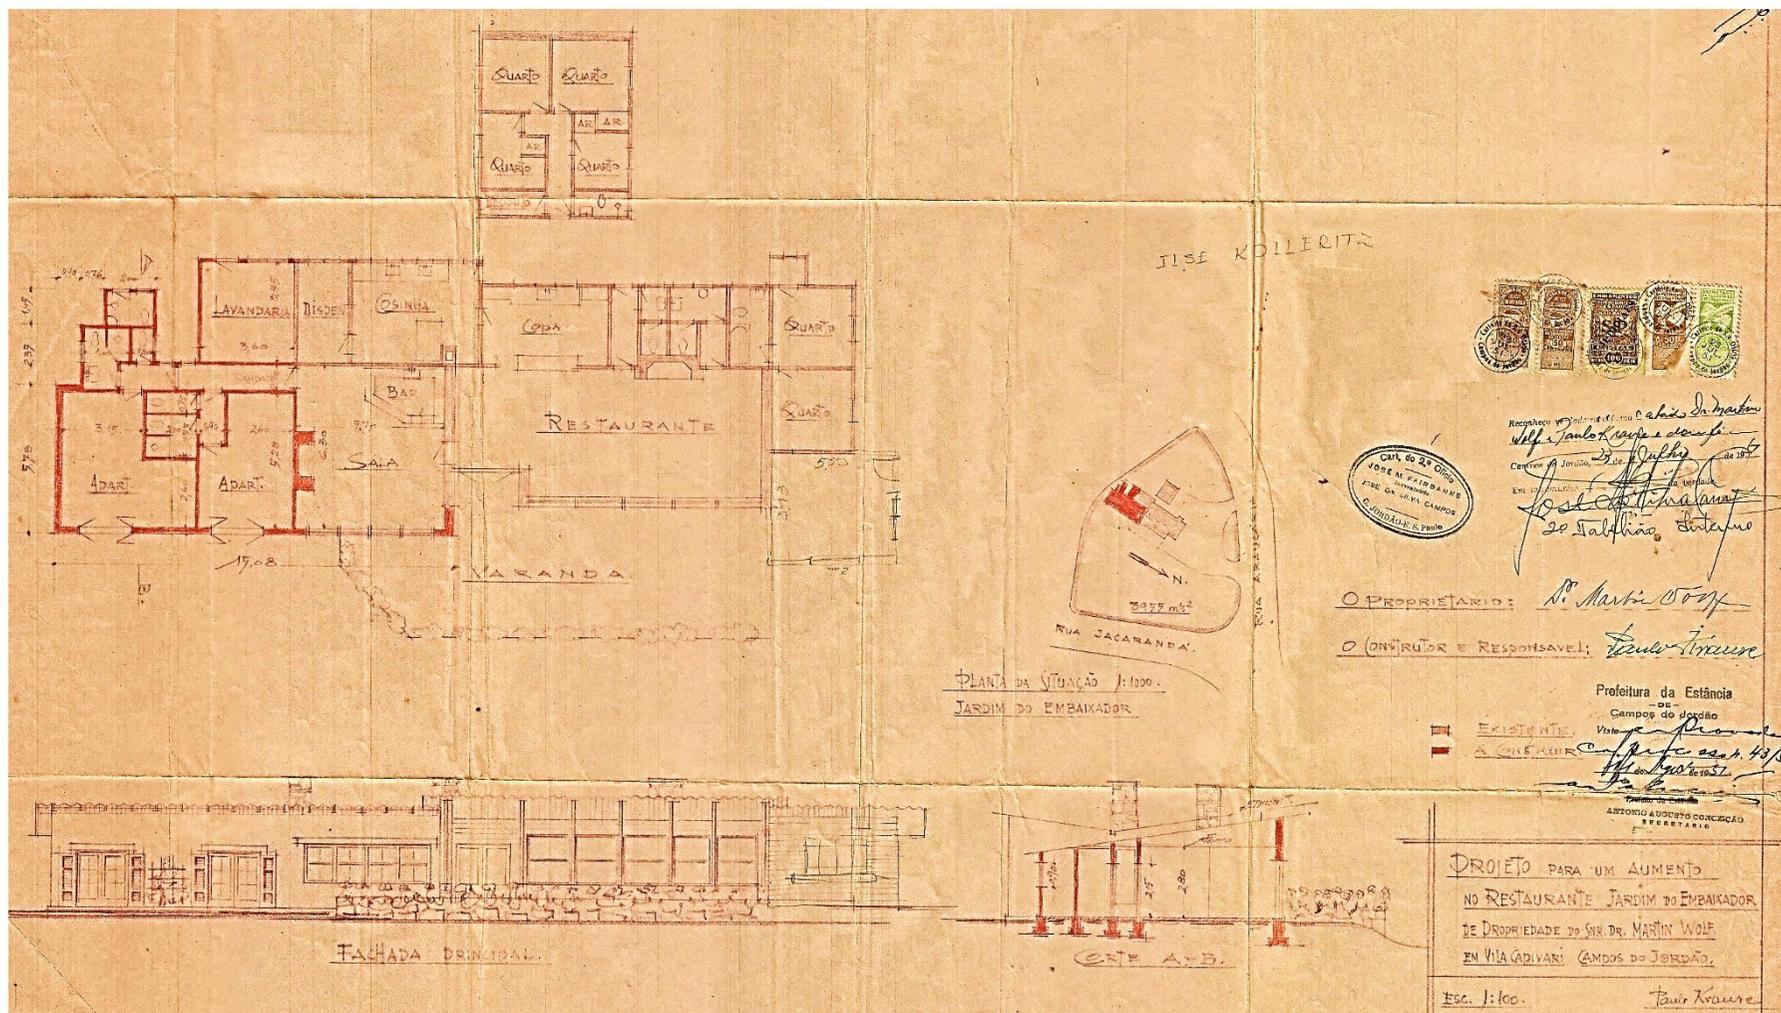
Planta, fachada principal e corte da ampliação de 1951.
